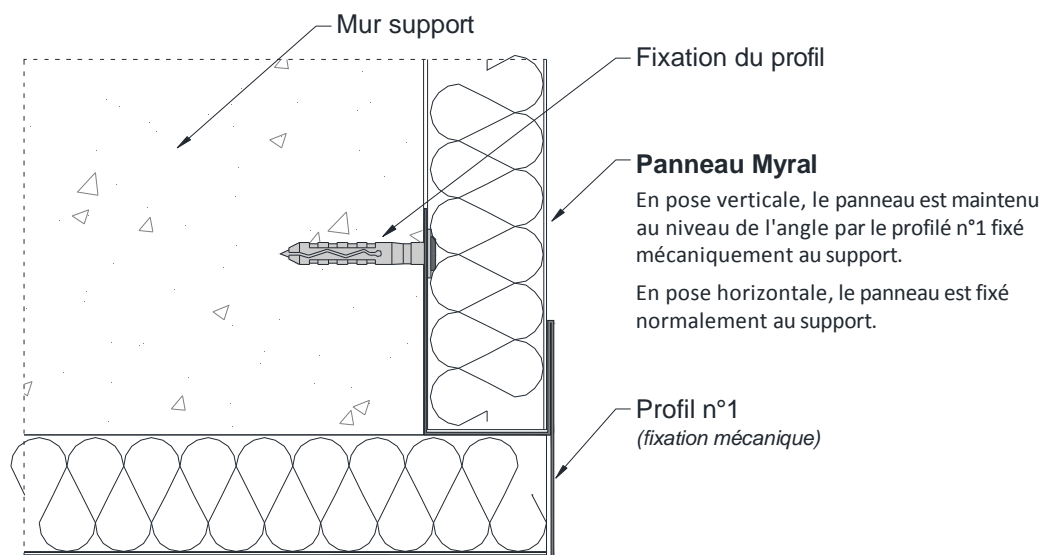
Angle sortant – Pose en vêtüre avec profil n°1, pose verticale (coupe horizontale)
